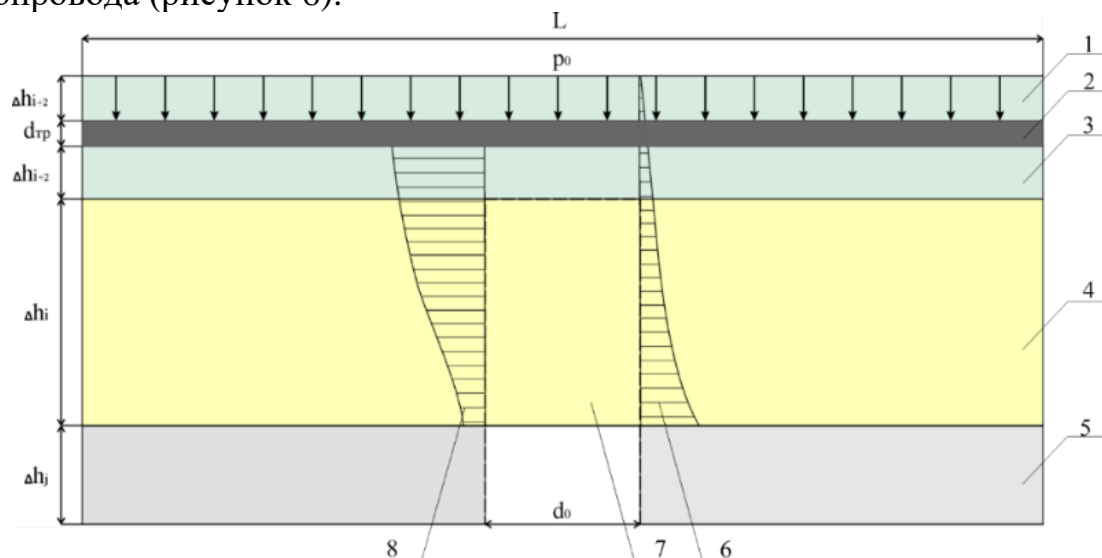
Схема расчета устойчивости цилиндра грунта над карстовой полостью с учетом нагрузки от подземного участка трубопровода: 1 – слой грунта засыпки, 2 – участок трубопровода, 3 – слой грунта подсыпки, 4 – покровная толща грунта, 5 – скальный карстующийся грунт, 6 – эпюра давления выше лежащих слоев грунта, 7 – цилиндрическая поверхность обрушения покровной толщи грунтов, 8 – эпюра напряжений от веса трубопровода; Δh_j – толщина j -го слоя грунта (скальный грунт), м; Δh_i – толщина i -го слоя грунта (покровная толща), м; Δh_{i+1} – толщина $i+1$ -го слоя грунта (слои покровной толщи грунта), м; Δh_{i+2} – толщина $i+2$ -го слоя грунта (грунт засыпки и подсыпки), м; d_0 – расчетный диаметр карстового провала, м; $d_{тр}$ – диаметр участка трубопровода с учетом изоляции, м; L – длина модели; p_0 – среднее удельное давление на единицу поверхности контакта трубопровода с грунтом, кПа
